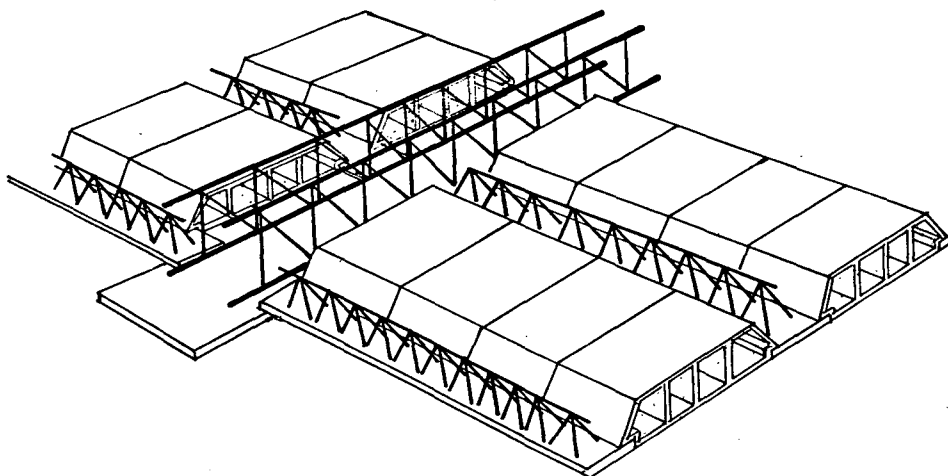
VIGOTES TRELIÇADOS (LAJE TRELIÇA)
